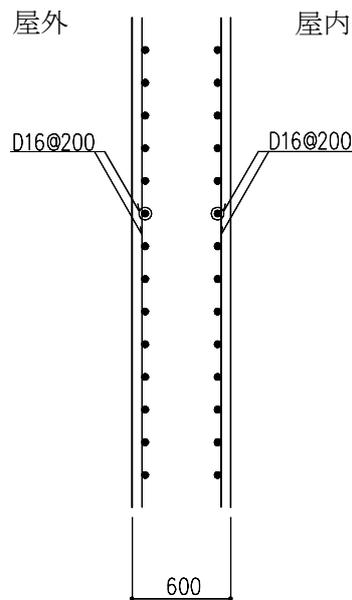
耐震壁の配筋図 (1階, YM通り X1~X2通り間) (単位: mm)
